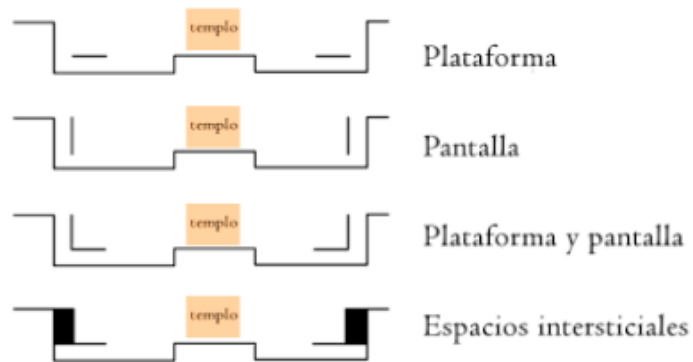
Galerías de piedra artificial cálida. Elaboración adaptada de Archdaily
